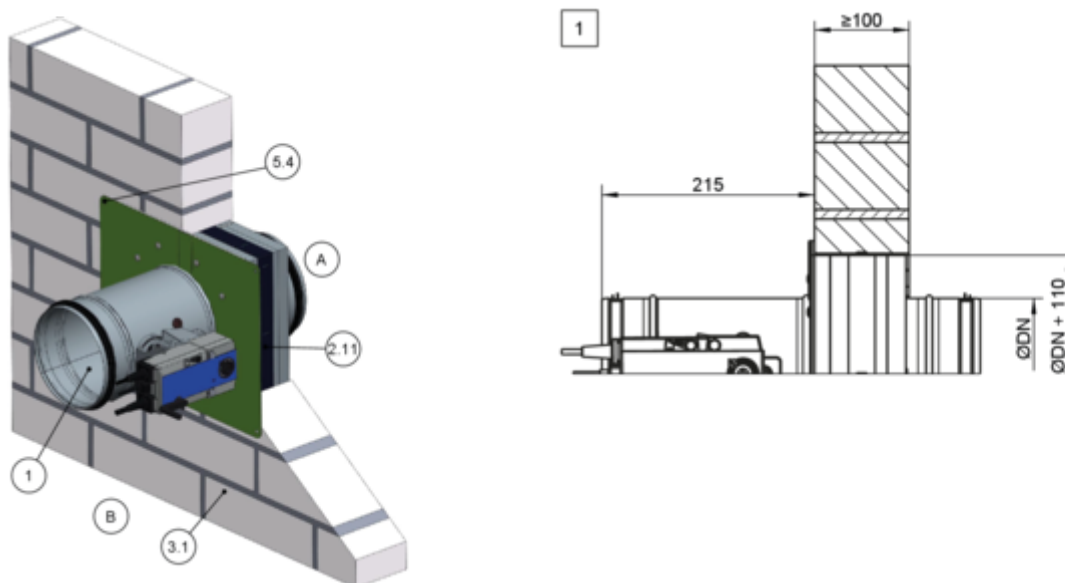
Installazione a secco senza malta in parete piena con blocco di installazione ER
